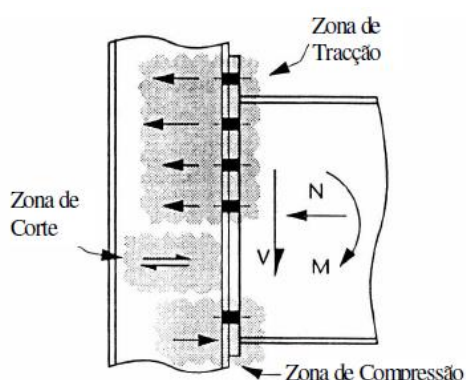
Zonas de esforços numa ligação viga-pilar, adaptado de (Silva, Simões, & Abecasis, 2008)
